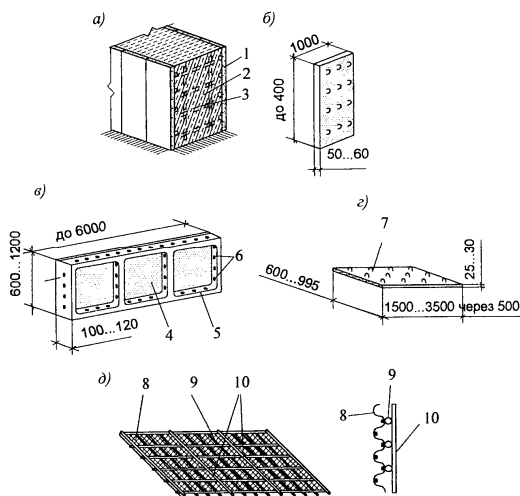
Незнімна опалубка з залізобетонних елементів:
